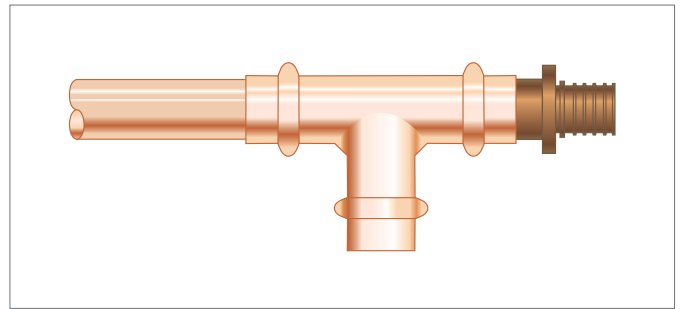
Racor a presión soldado RAUTITAN RX con sistema a presión de cobre
